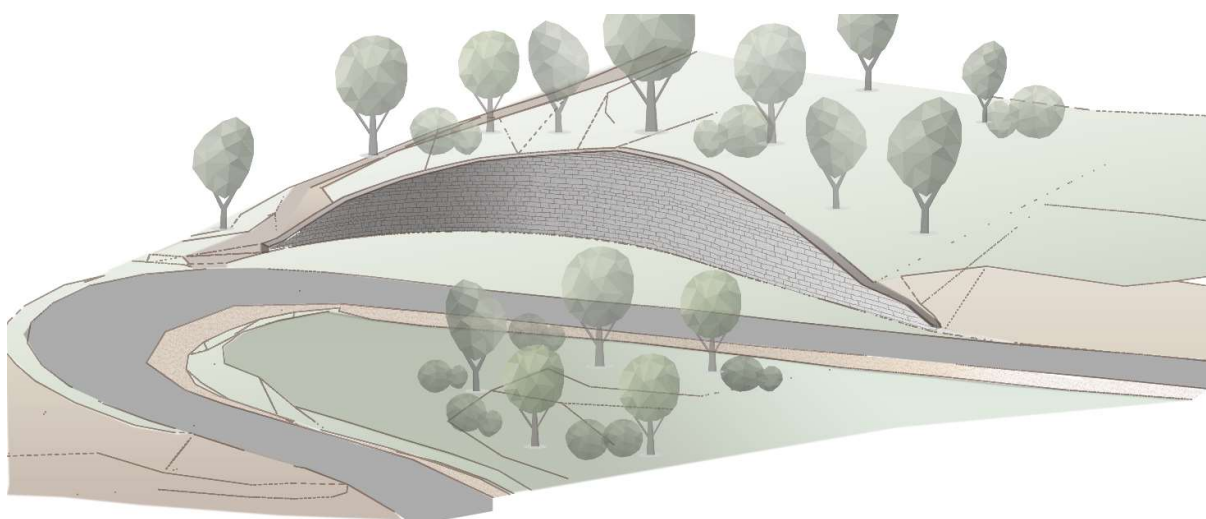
Vista prospettica dell'OB.42 (Vista 2)
